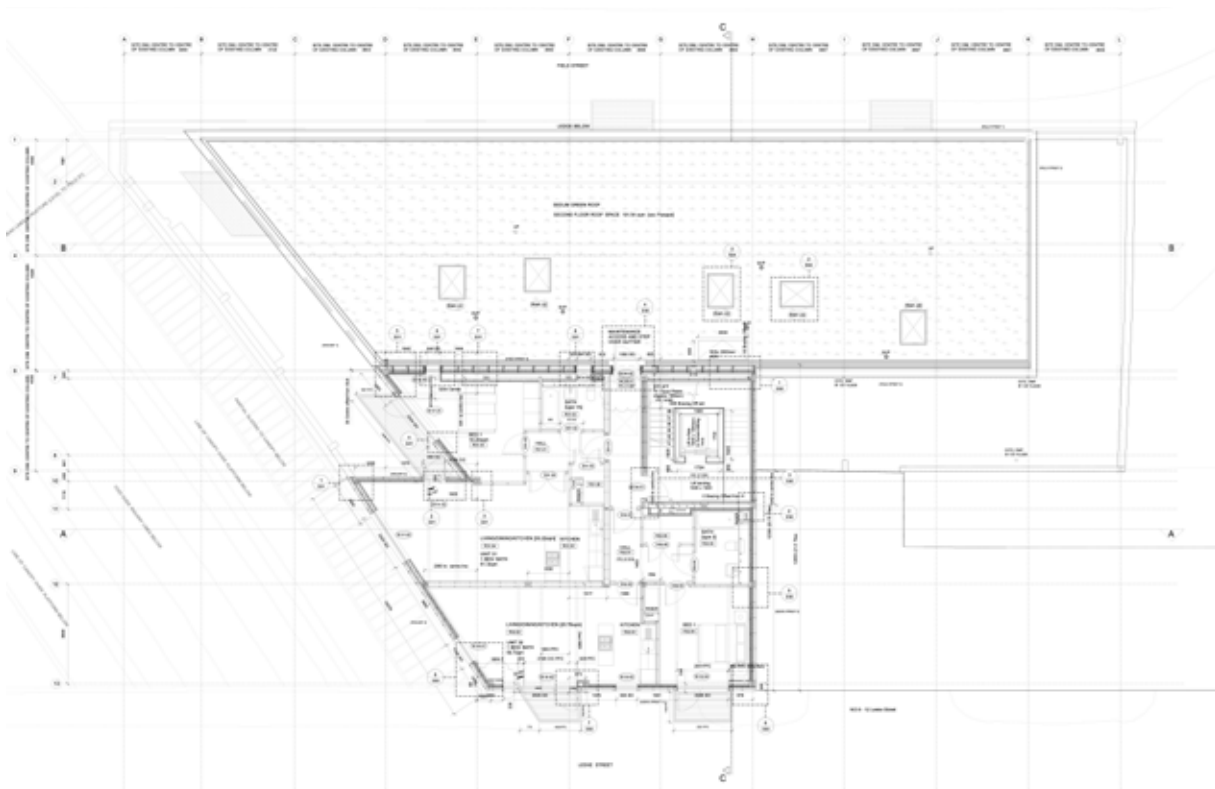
Grundriss 3.OG © Project Orange
